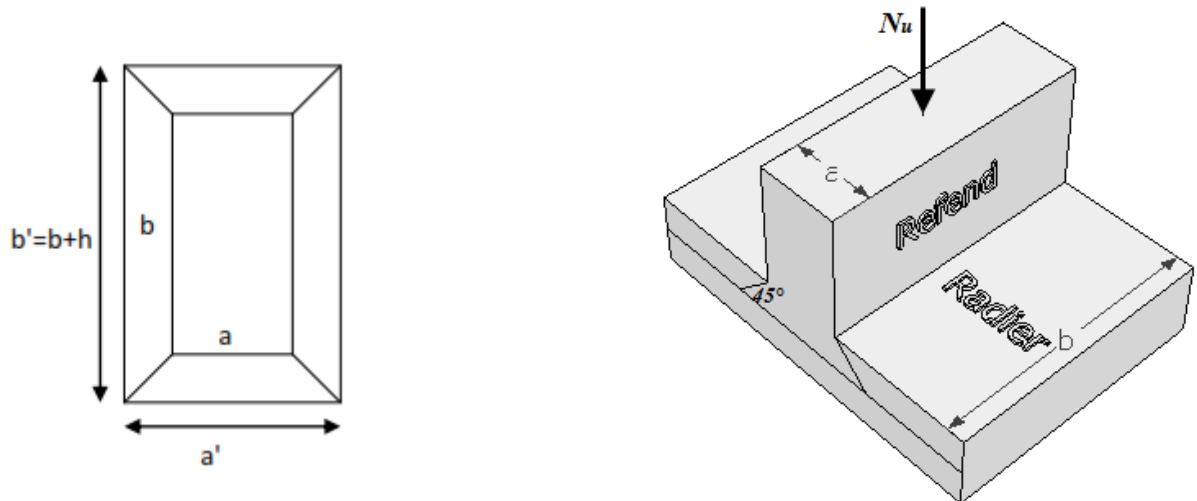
Périmètre utile des voiles et des poteaux.
